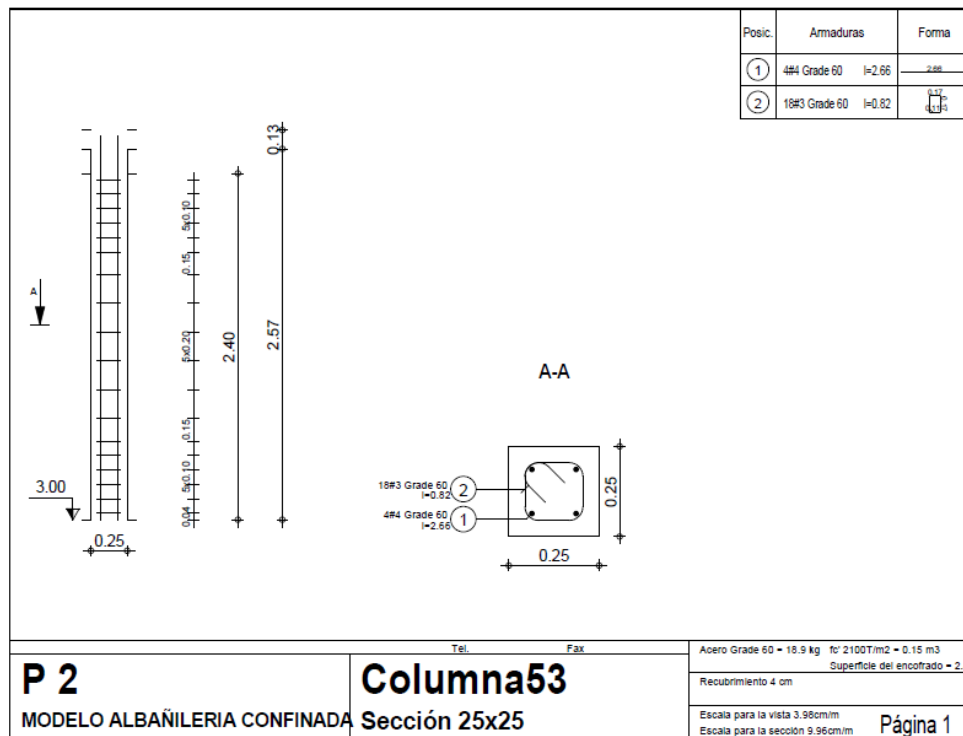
Plano de ejecución por defecto de la columna en Robot.
